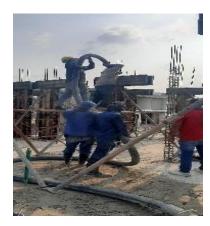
Vaciado en concreto muros estructurales y columnas, segundo piso
